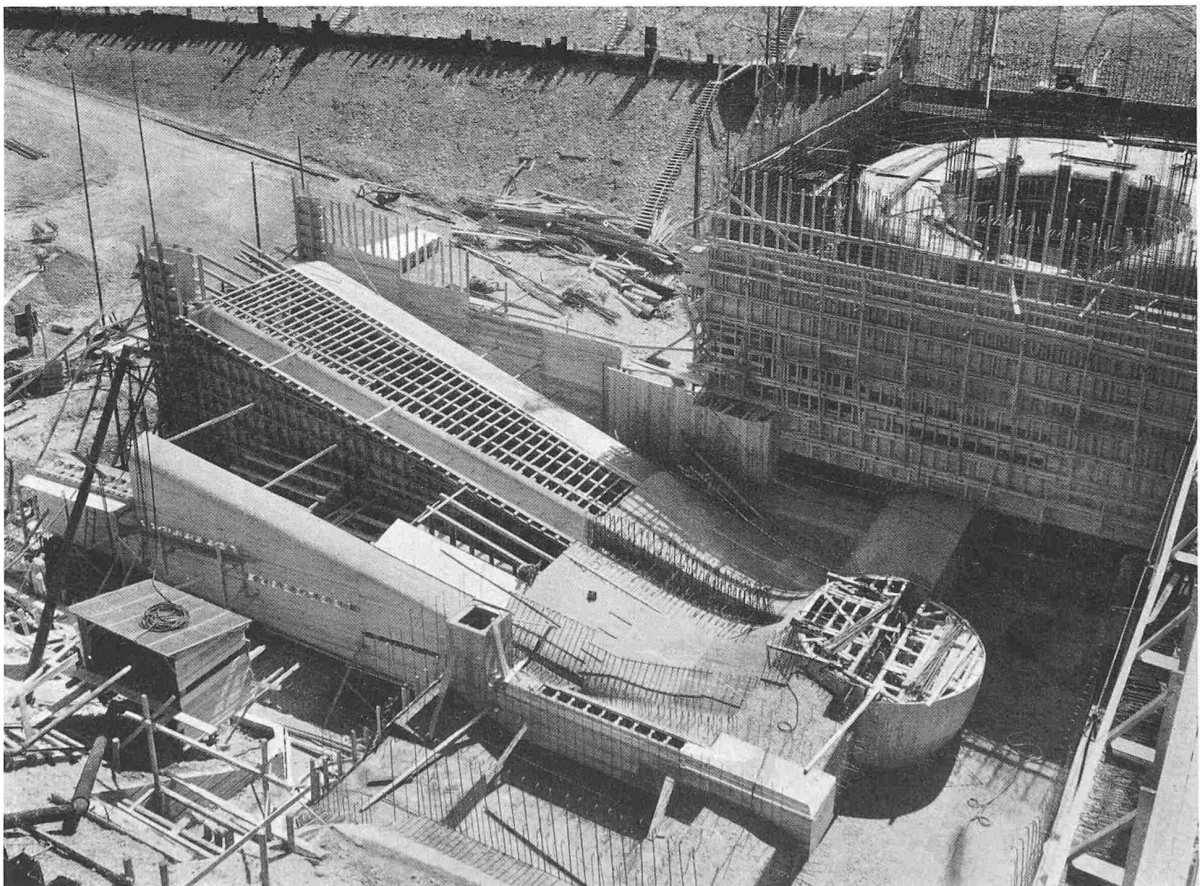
Maschinenhaus. Schalung des Saugrohres der Maschinengruppe 1. 23. August 1950
